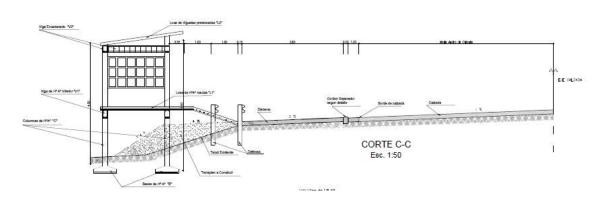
Perfil Darsenas de Pasajeros- fuente: Proyecto de Ingeniería
